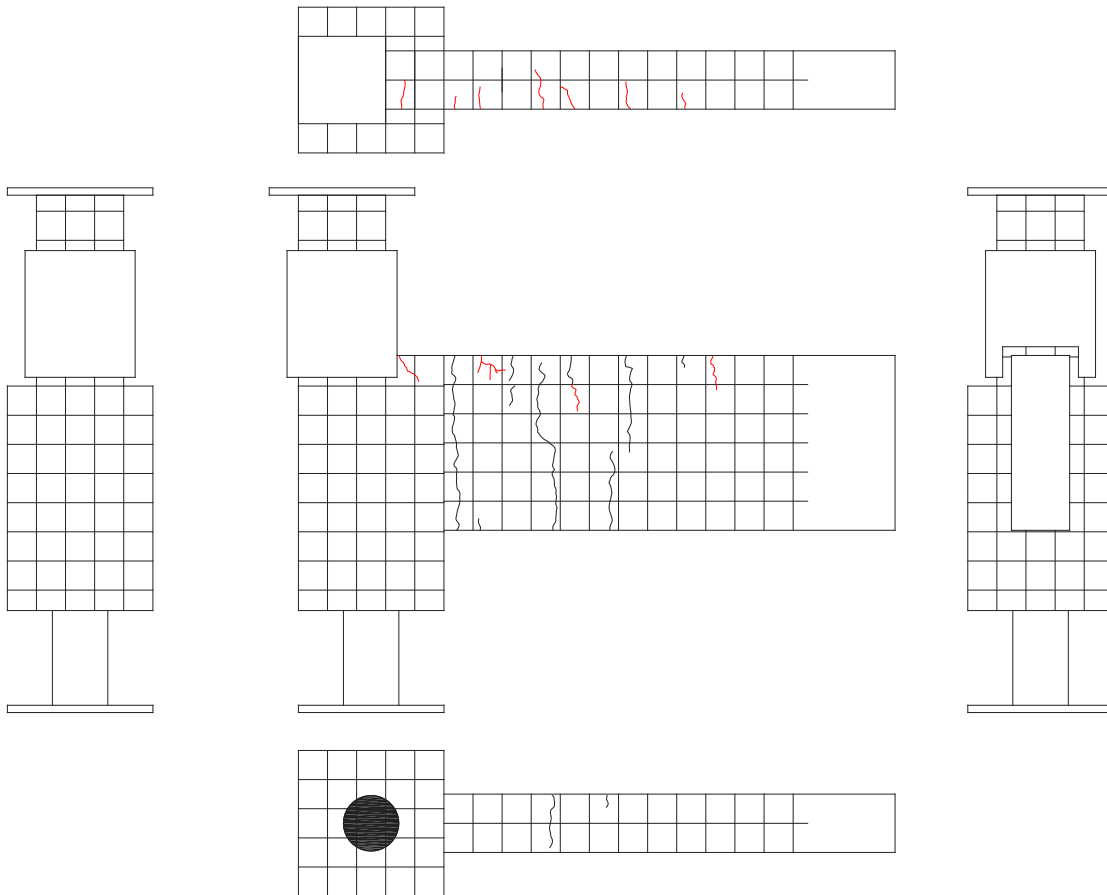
3. 90 試験体 C-1 ひび割れ状況 (7Cycle)
